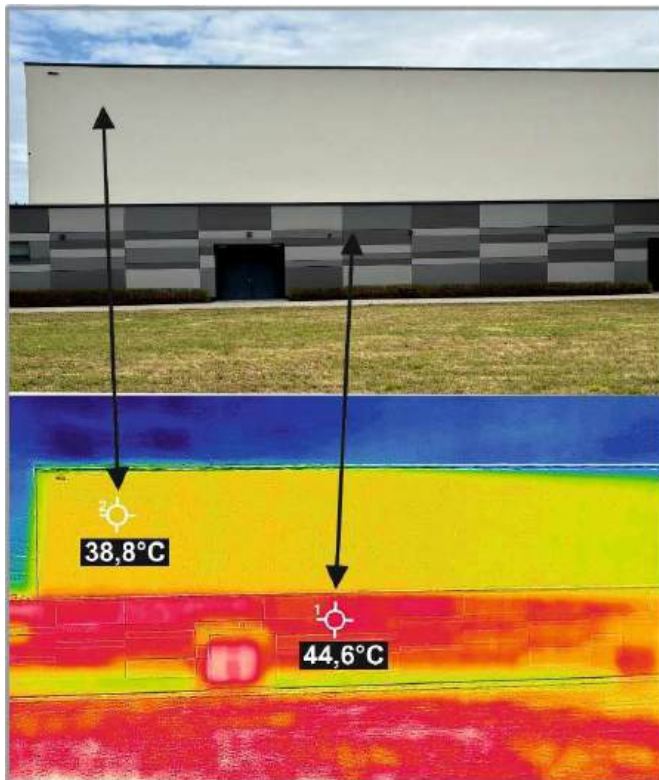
Oberflächentemperaturen heller und dunkler Fassaden
